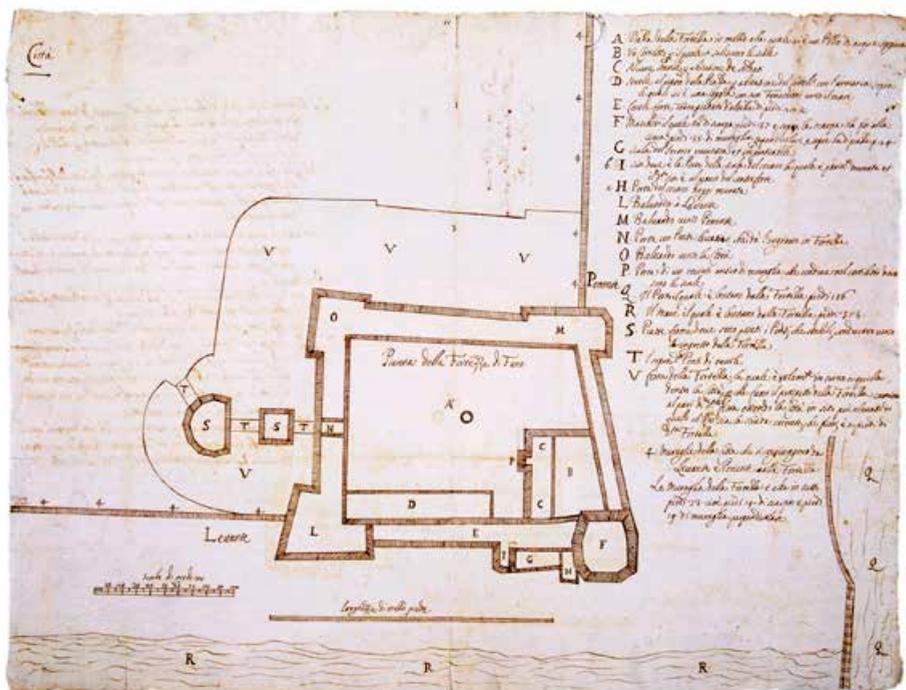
Archivio Segreto Vaticano, Piante e Carte Geografiche, 54, Pianta della Fortezza di Fano, Rinolfo Galassi Castellano, 9 marzo 1664.
